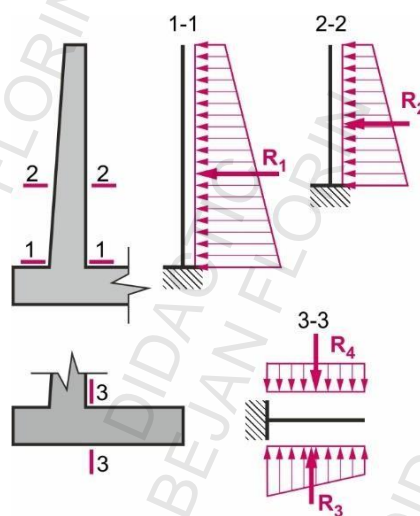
Schemele statice pentru determinarea momentelor încovoietoare și a forțelor tăietoare
